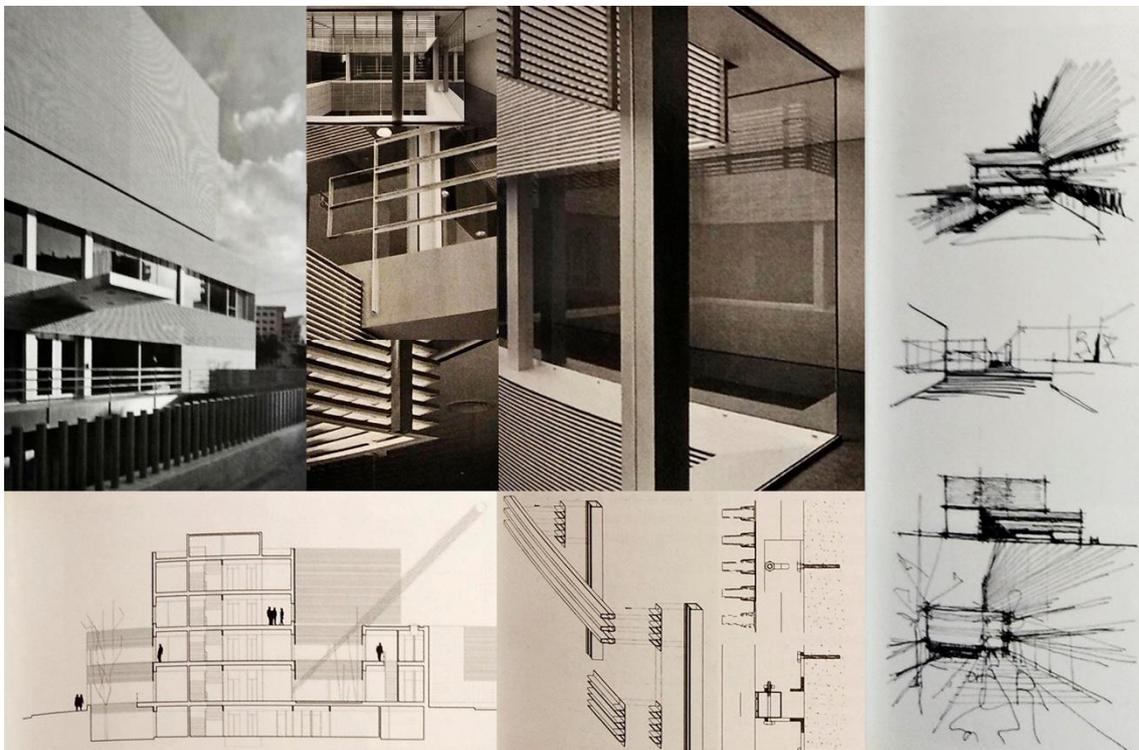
Vistas exteriores, vistas interiores, bocetos, sección y detalle constructivo de lamas.
